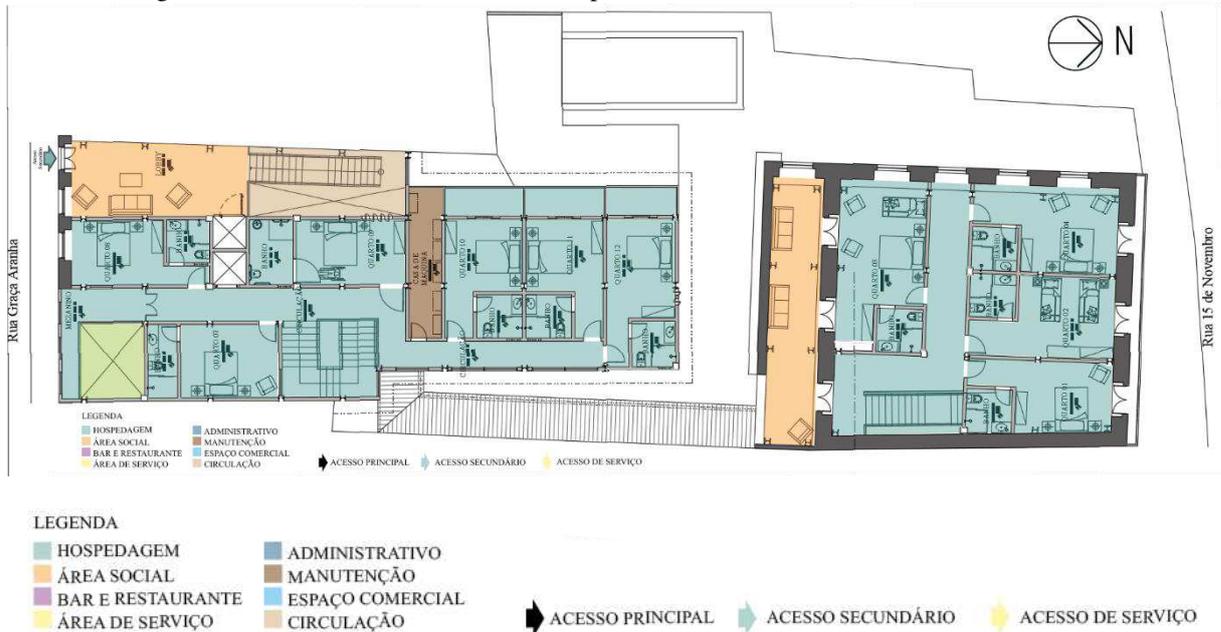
Planta Baixa do Pavimento Superior do Imóvel s/n e do Térreo do Imóvel 51.
